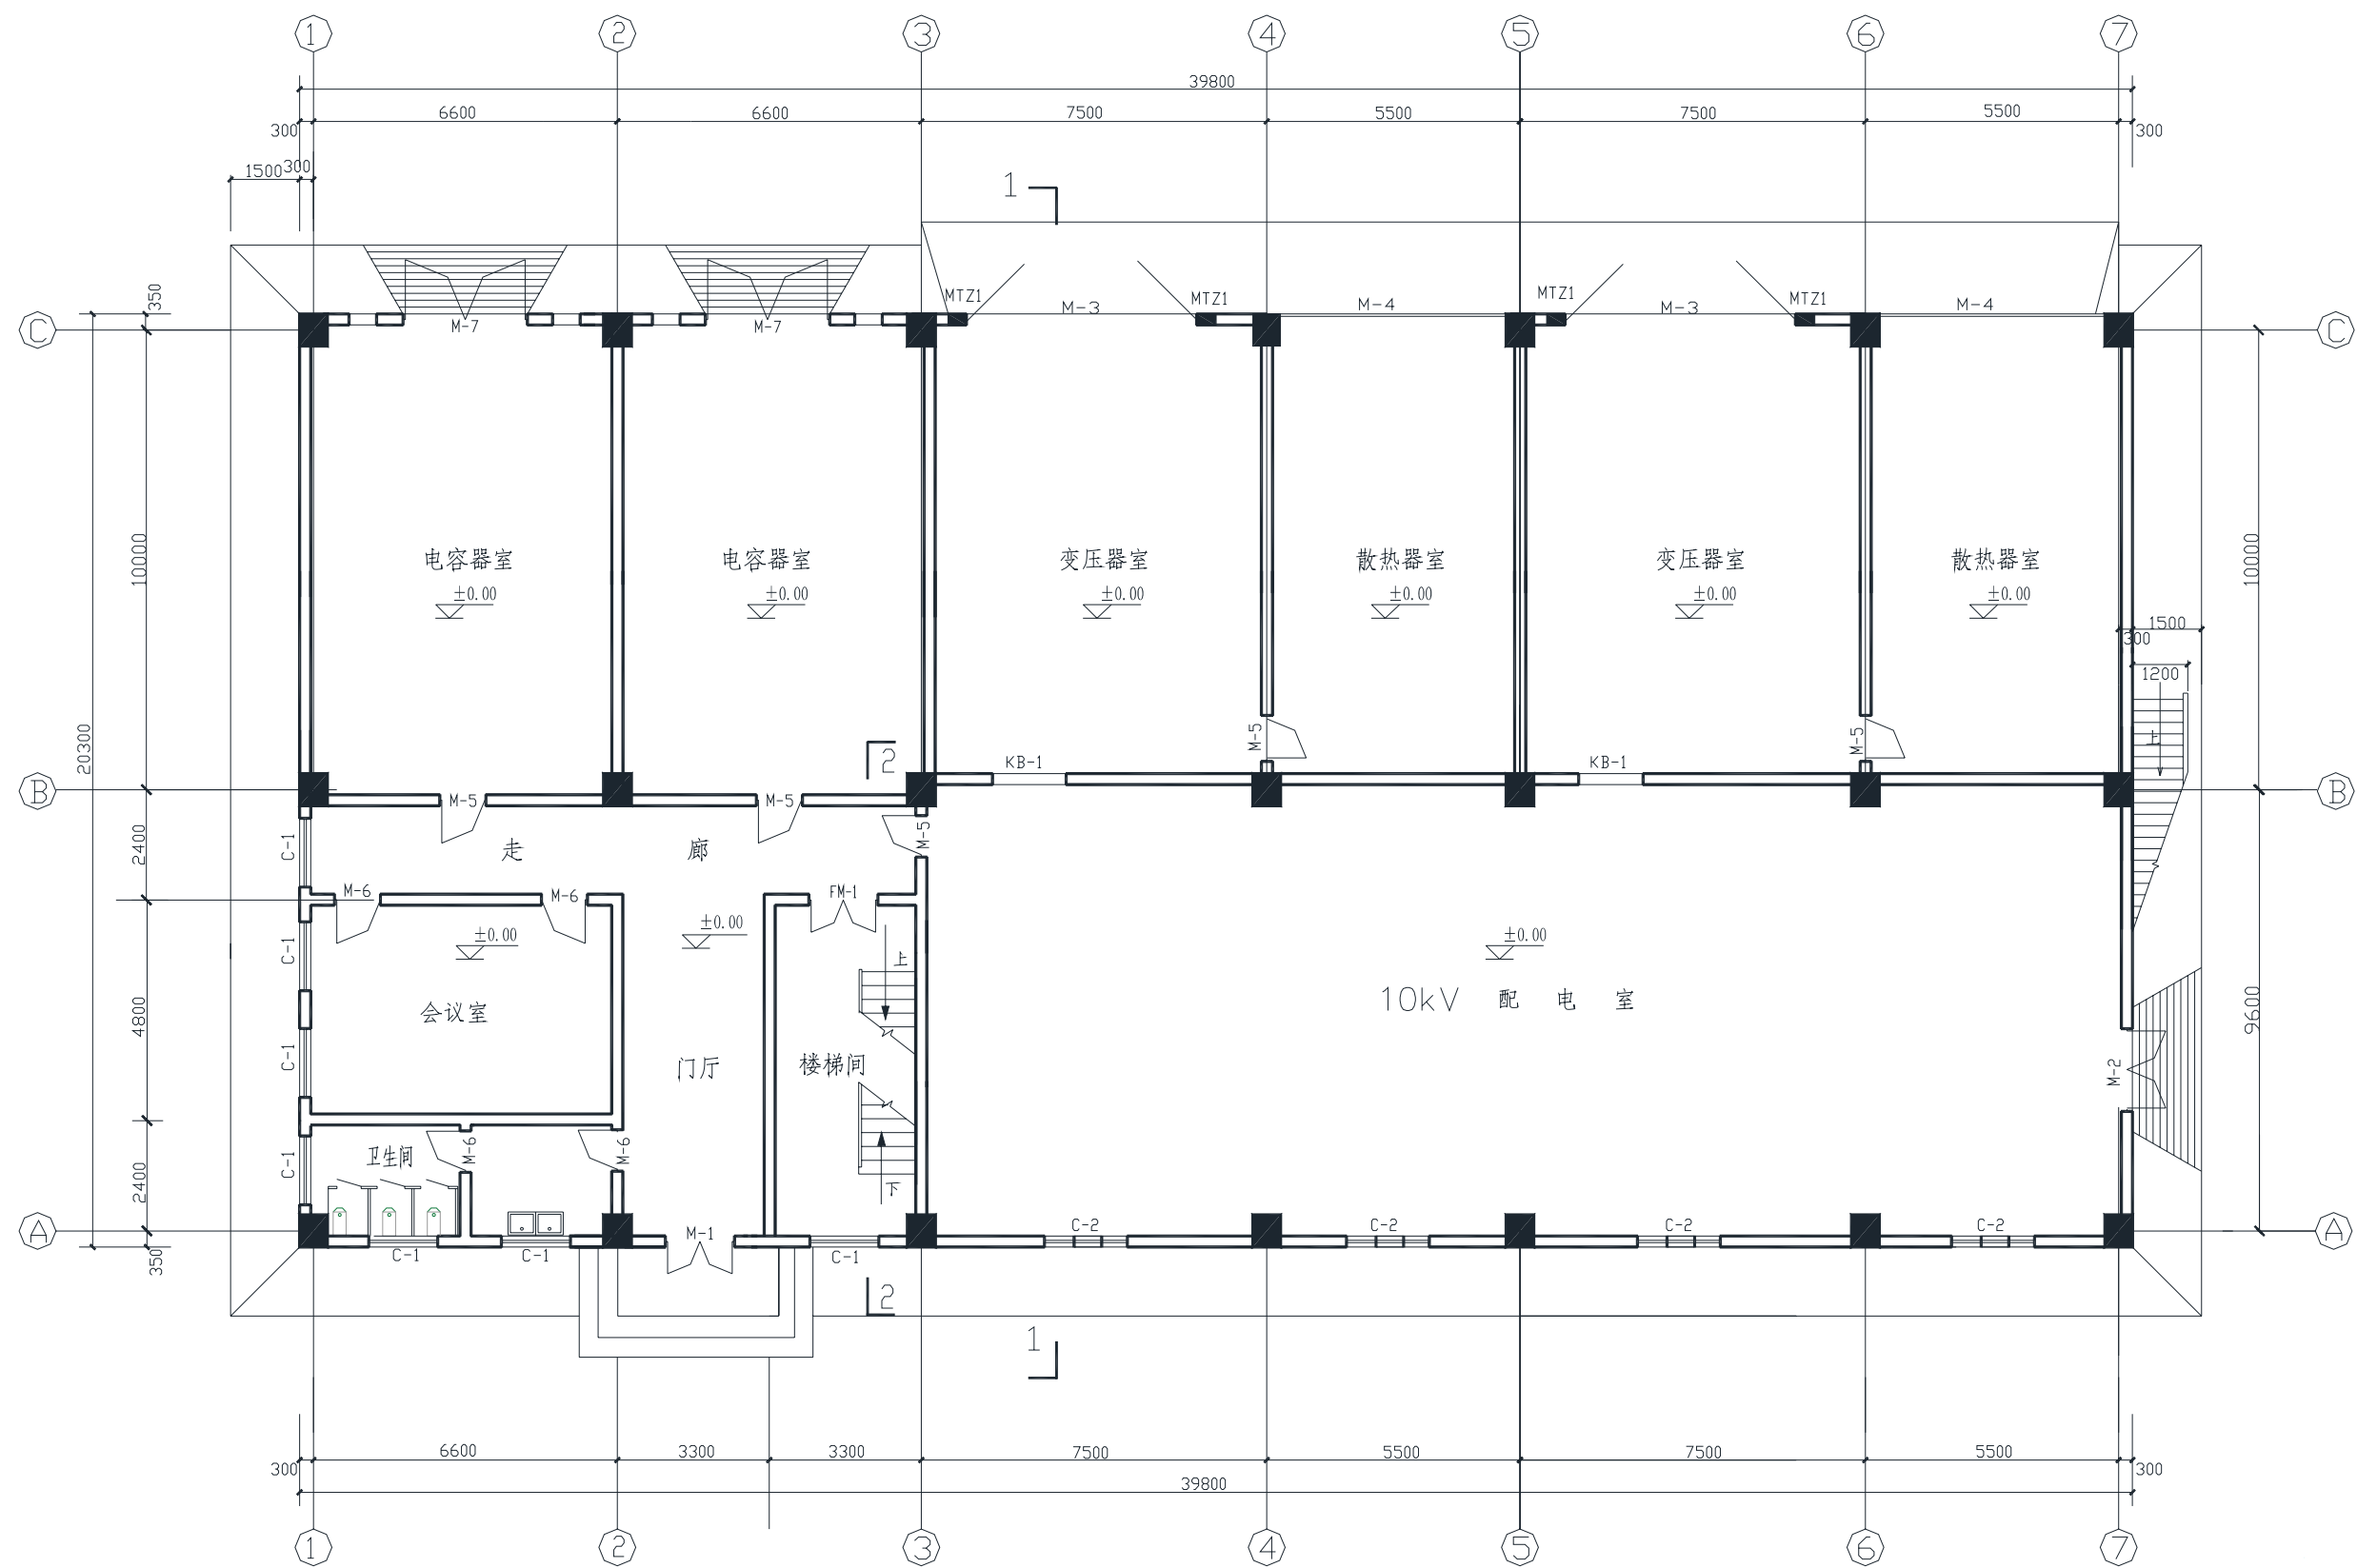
综合配电楼一层平面布置图(A2-2-06)
